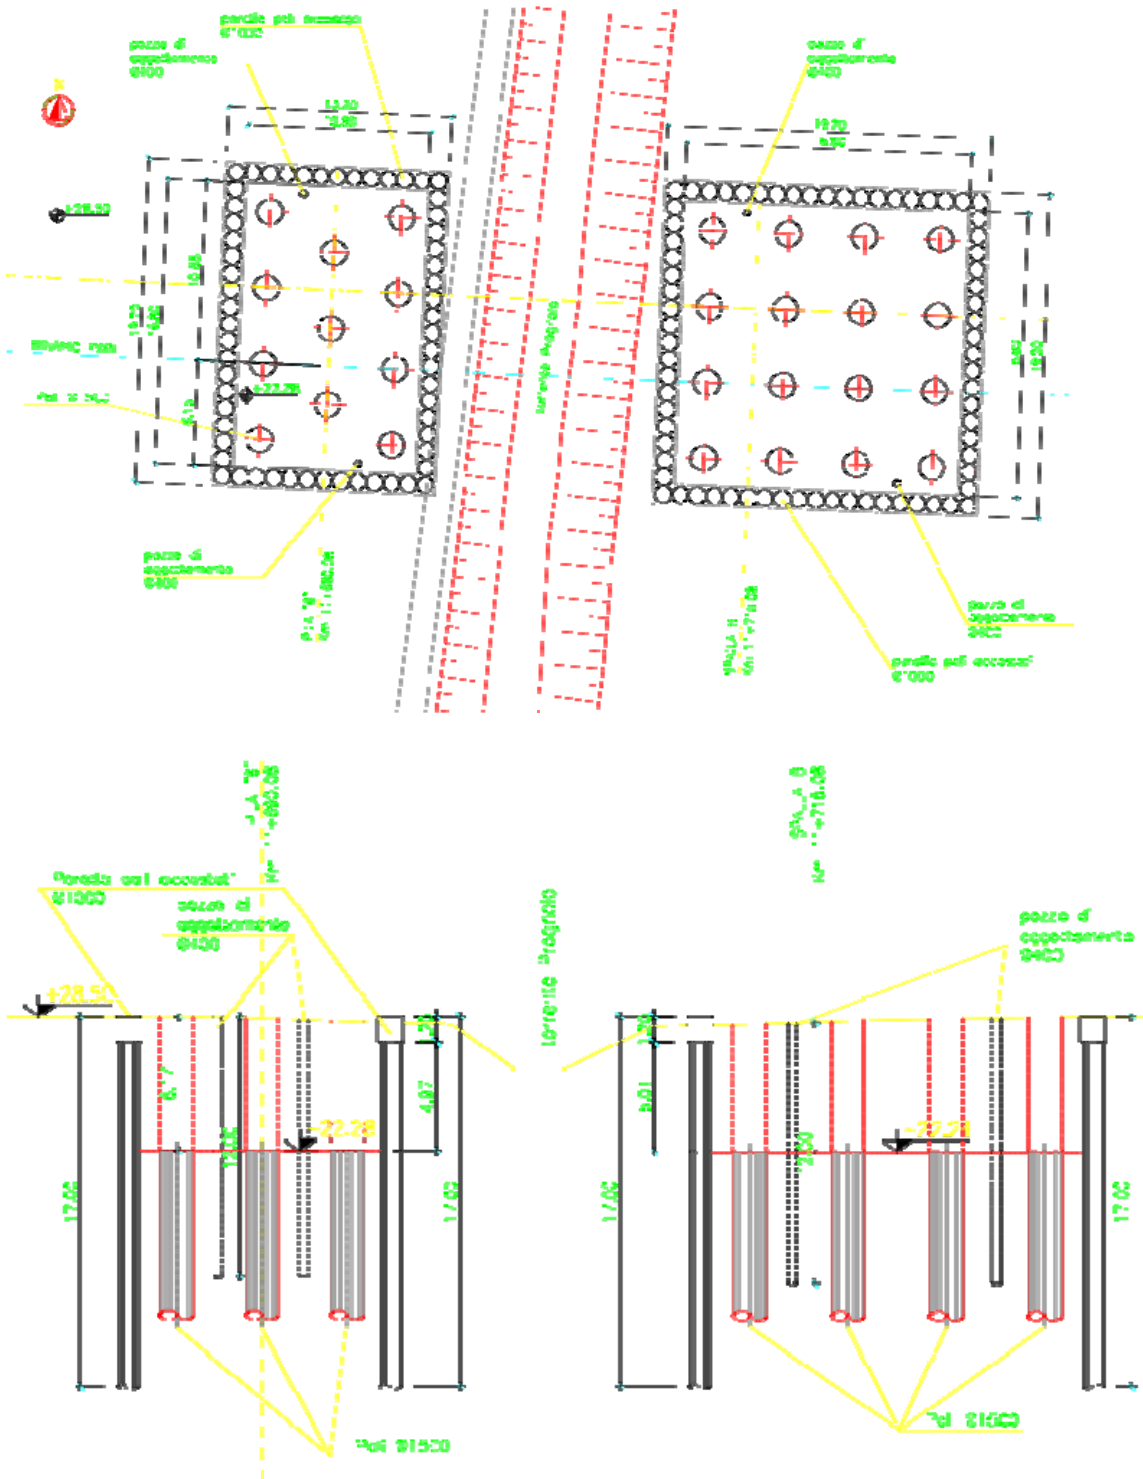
Geometria scavo Pila n.6 e Spalla Est
